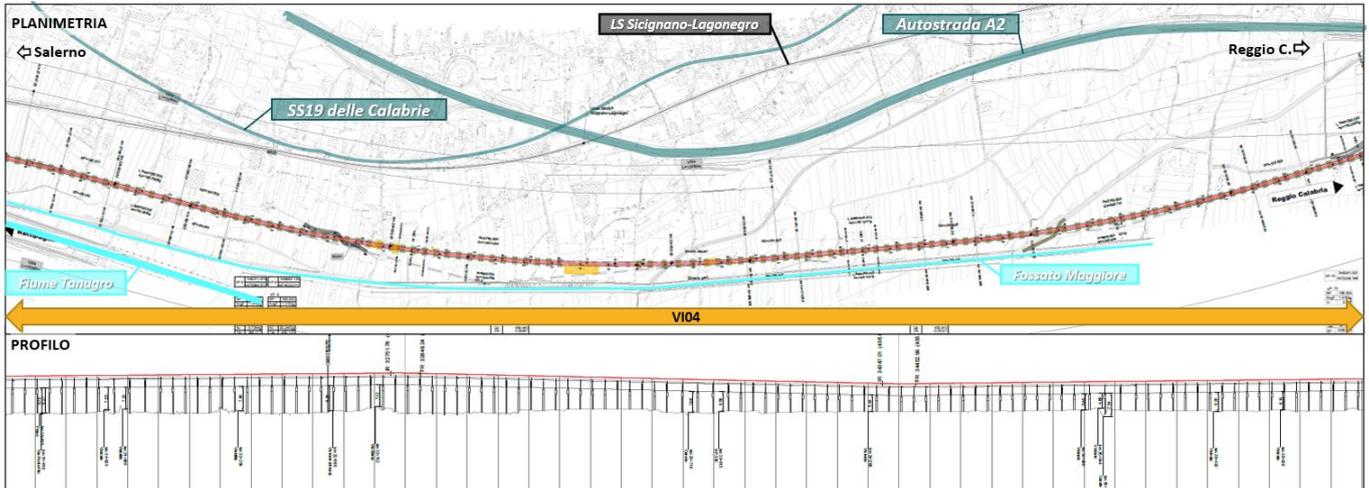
Planopprofilo di progetto da km 32+300 a km 35+100
